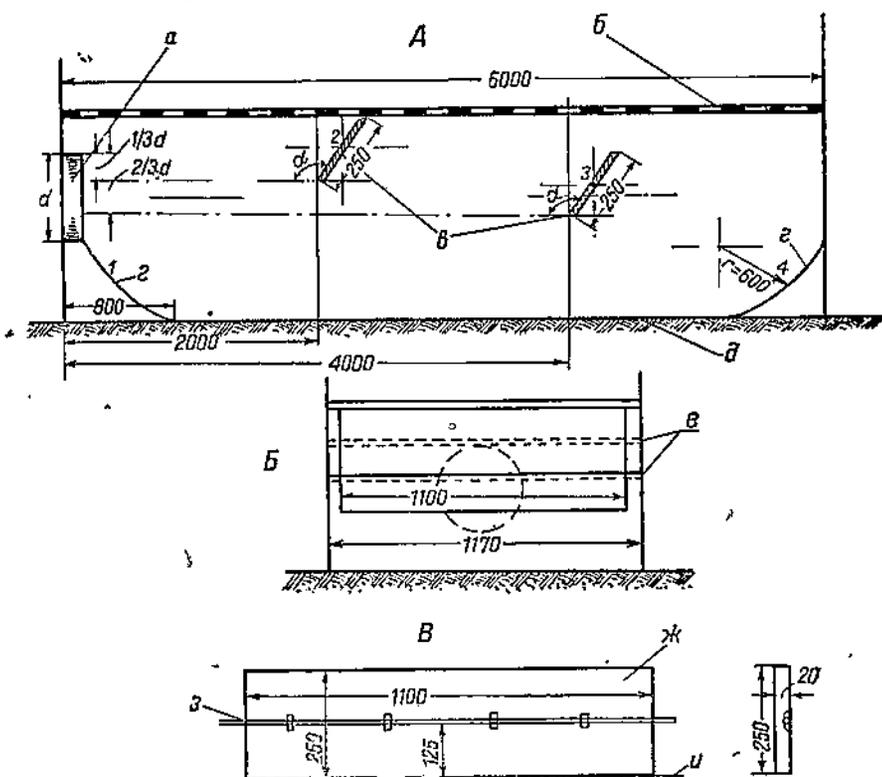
Схема расположения направляющих щитков в камерах сушилки: А—продольный разрез камеры: а—подводящий воздуховод, б—решетка нижнего яруса, в—щитки, г—фанерные щитки, д—пол камеры; Б—поперечный разрез; а—круглое железо; в—щиток; ж—доска, з—ось, и—палец крепления щитка
